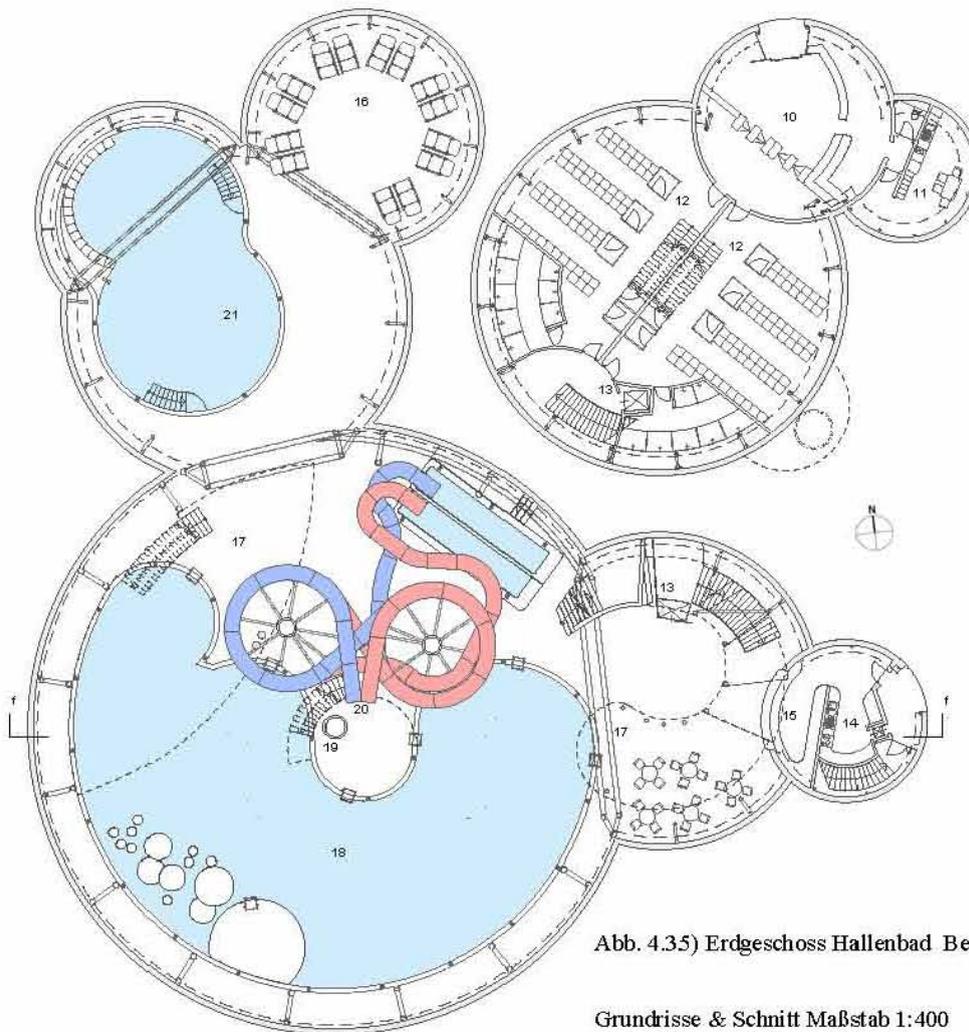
Erdgeschoss Hallenbad Beckenbereiche
